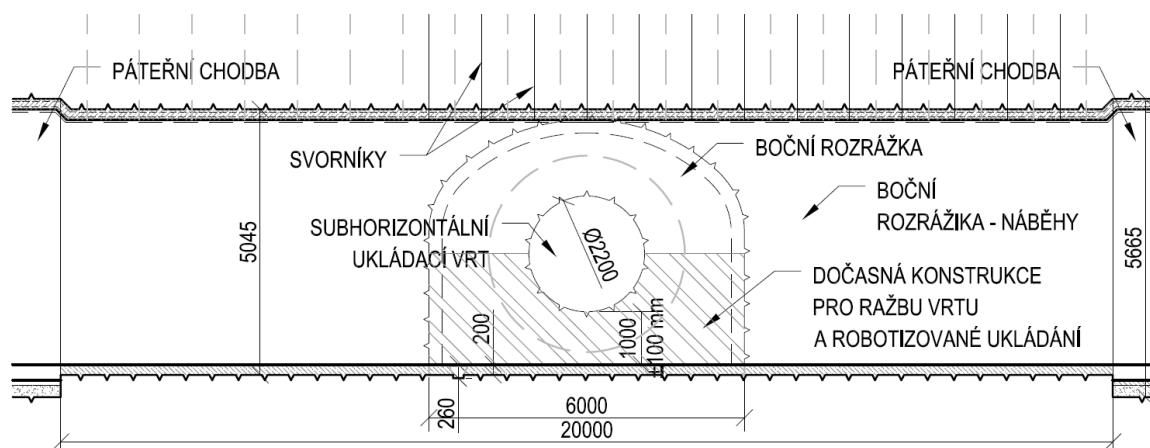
Příčný řez 2-2' boční rozrážkou – varianta D3
